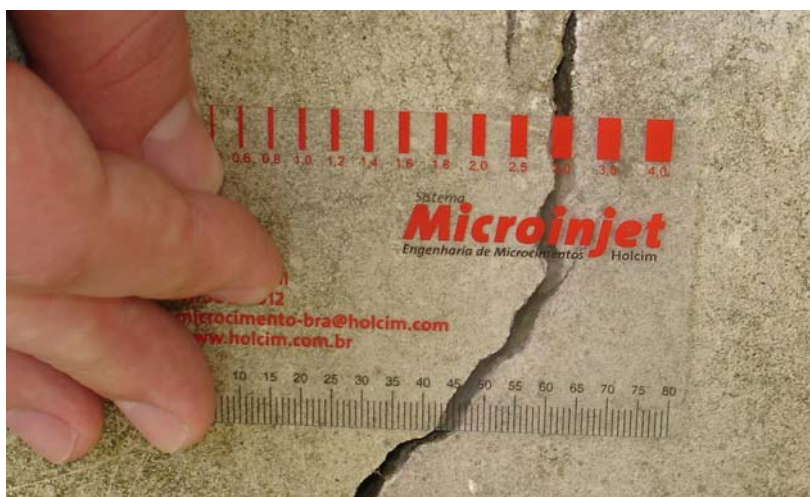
Fissurômetro: medida da abertura da fissura.
